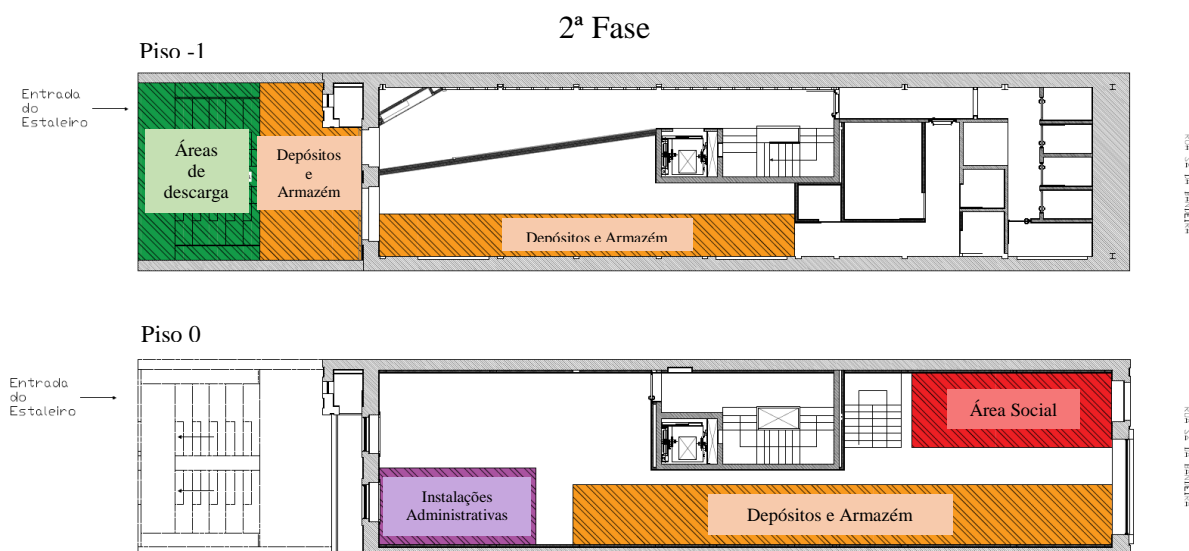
Planta do estaleiro da obra Sá da Bandeira na 2ª Fase
